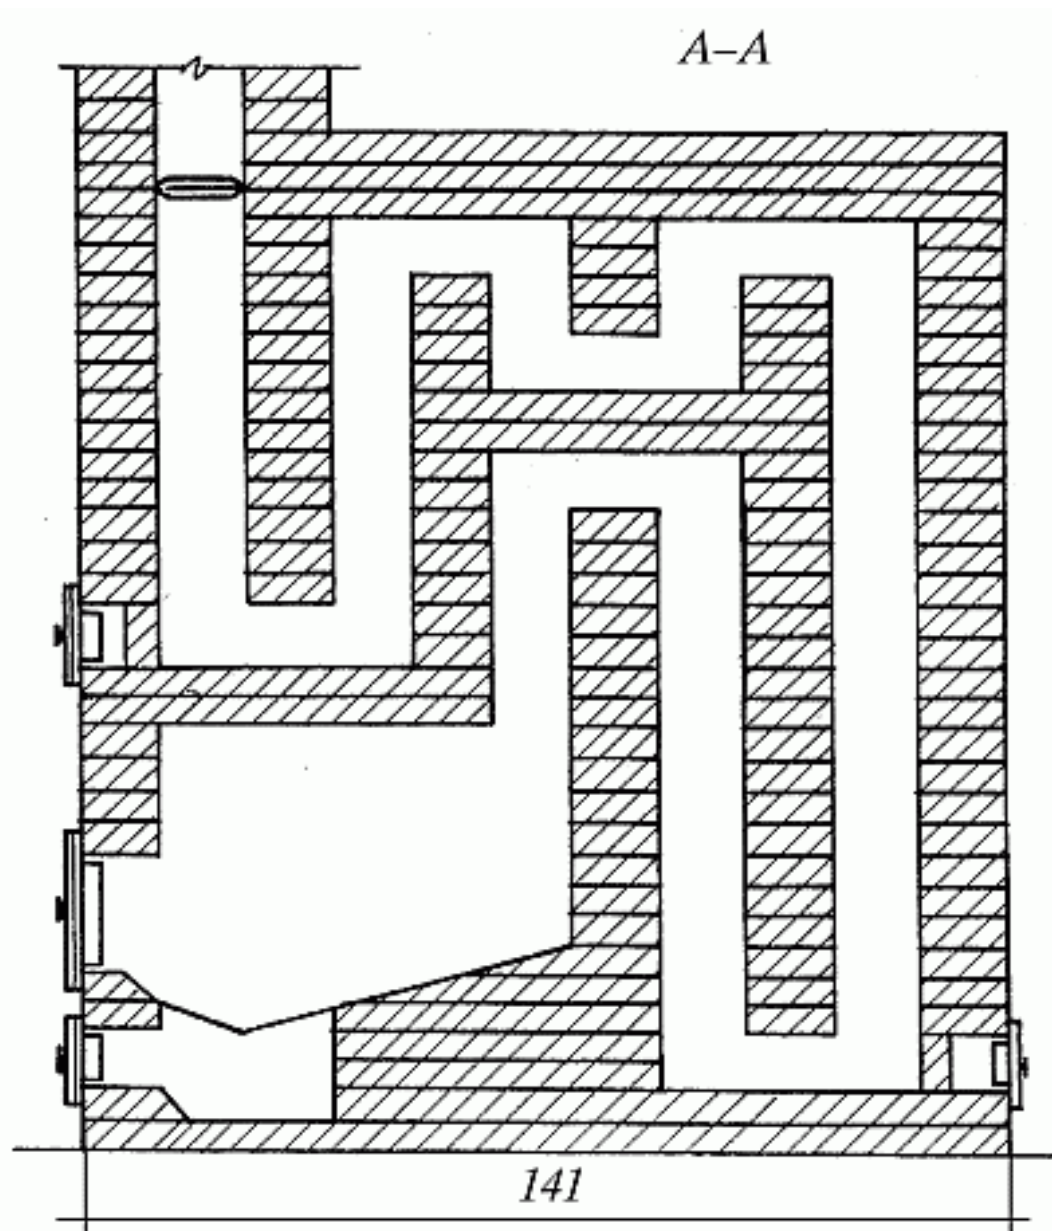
Прямоугольная печь, конструкция 2. Последовательность кладки
